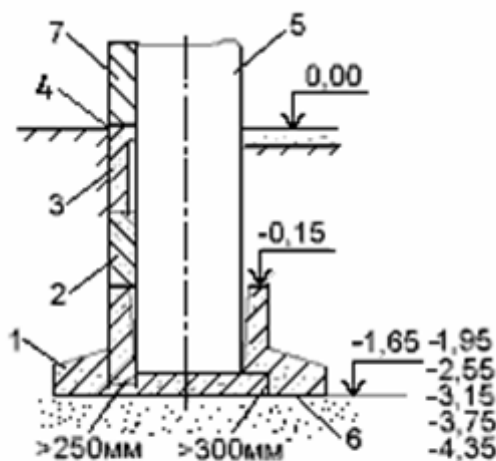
Схема отдельно стоящего сборного фундамента
